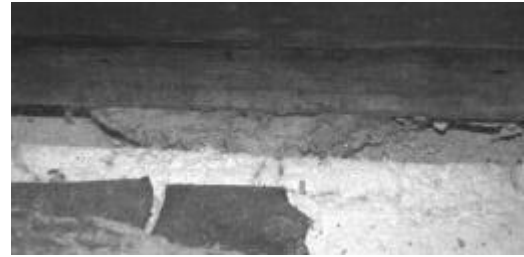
Eine andere Rohrführung hätte vermutlich nicht zu den Mörtelbrücken (Schallbrücken) geführt
